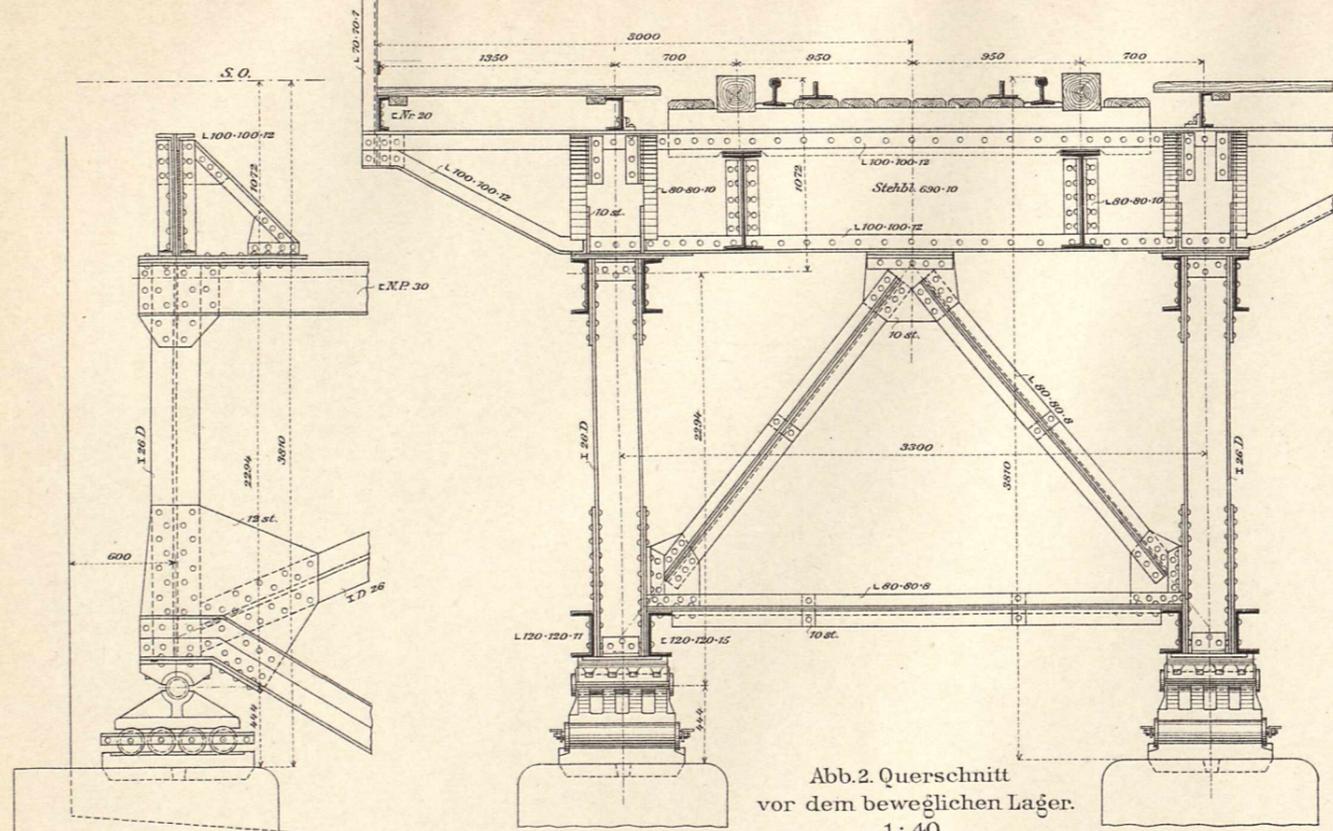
Querschnitt vor dem beweglichen Lager. 1: 40.
